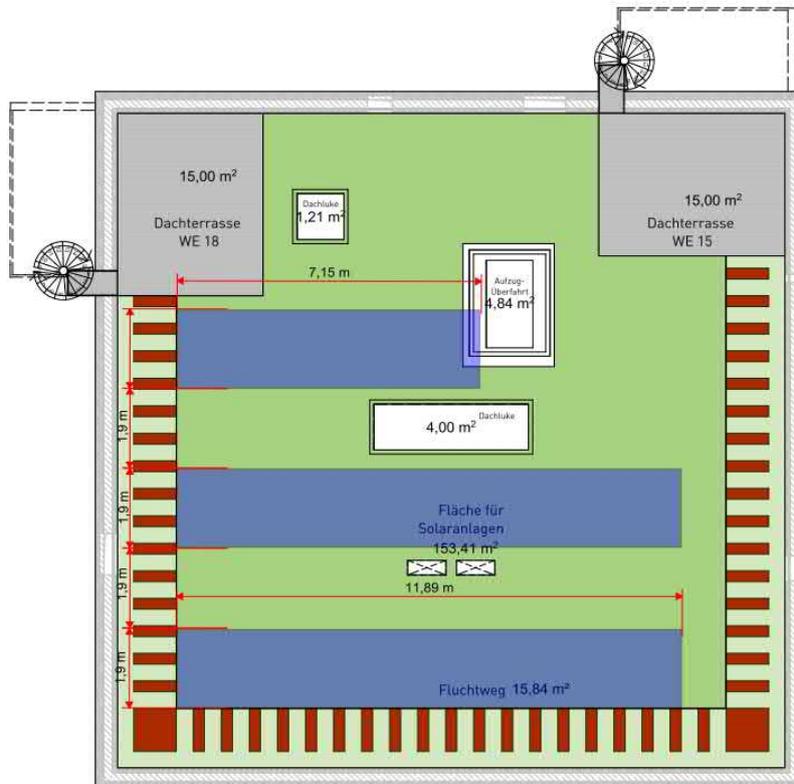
Dachaufsicht eines 6-geschossigen Gebäudes mit Kollektorfeld (Vorplanung)
